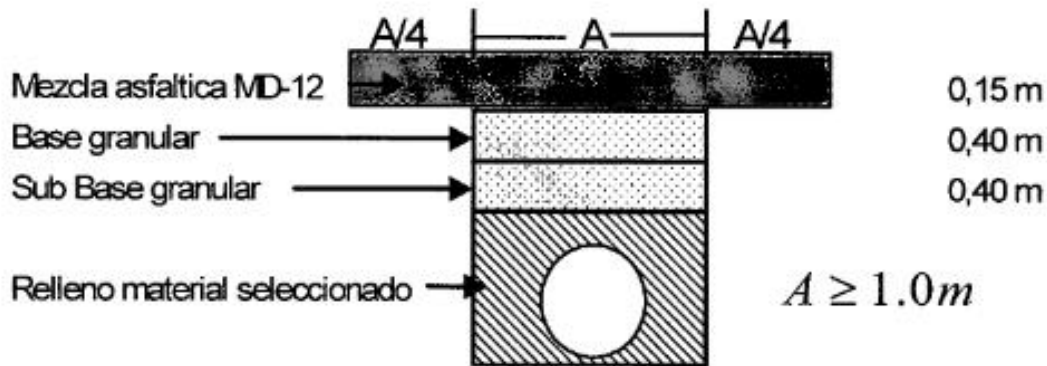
Sección de estructura de pavimento requerida por el IDU para pavimentos locales.
